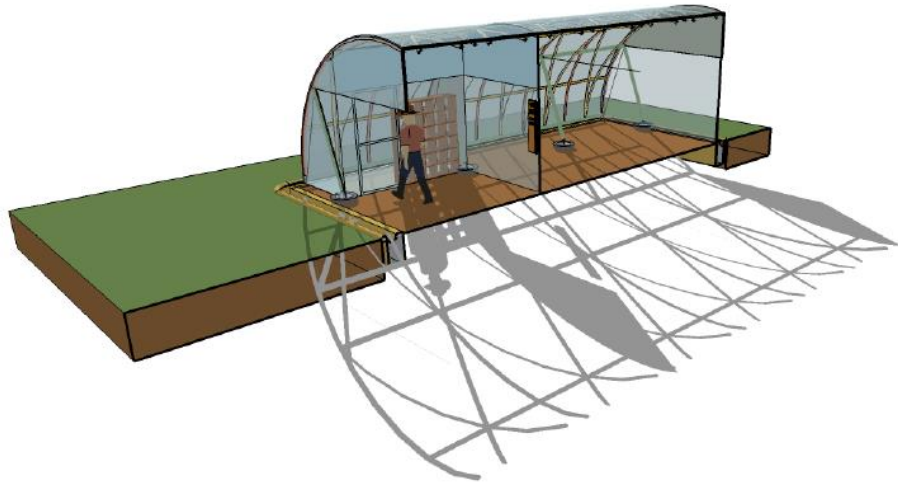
Corte longitudinal de la estructura principal del invernadero y las 2 subdivisiones.
